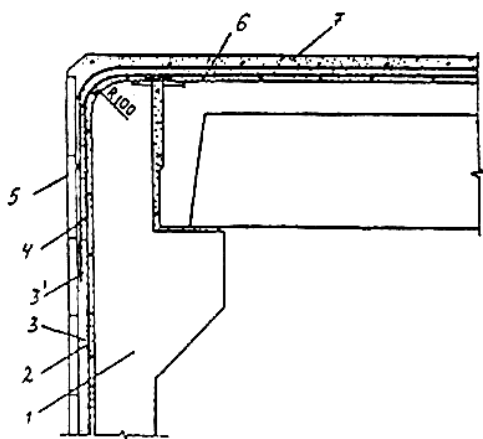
Конструкция гидроизоляции стен и перекрытия тоннеля:
